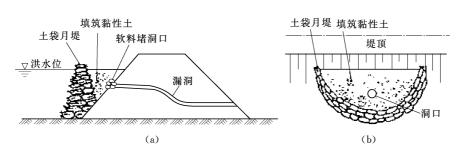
临水筑月堤示意图 (a) 断面图; (b) 平面图
